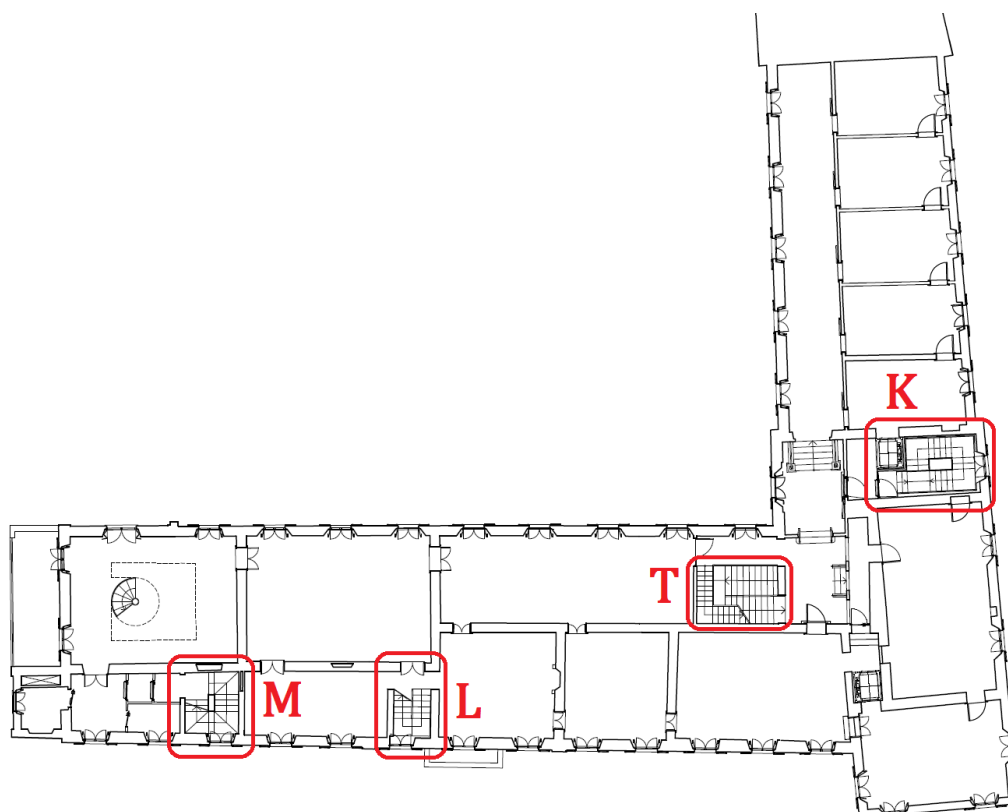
Ubicazione dei nuovi vani scala, pianta 1° piano
